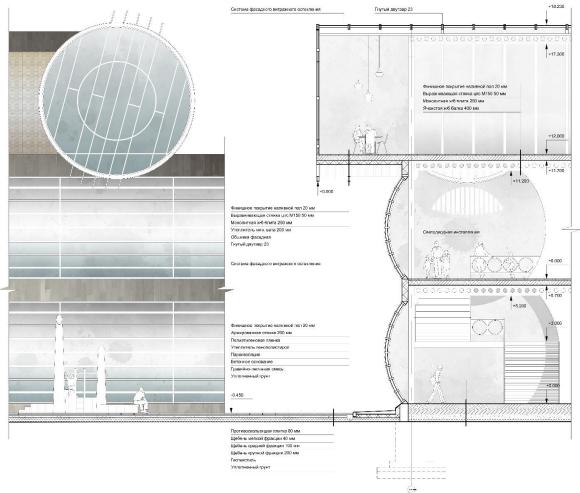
Разрез по стене и фрагмент фасада детского культурно-досугового центра Fig. 8. Section along the wall and a fragment of the facade of the children's cultural and leisure center
